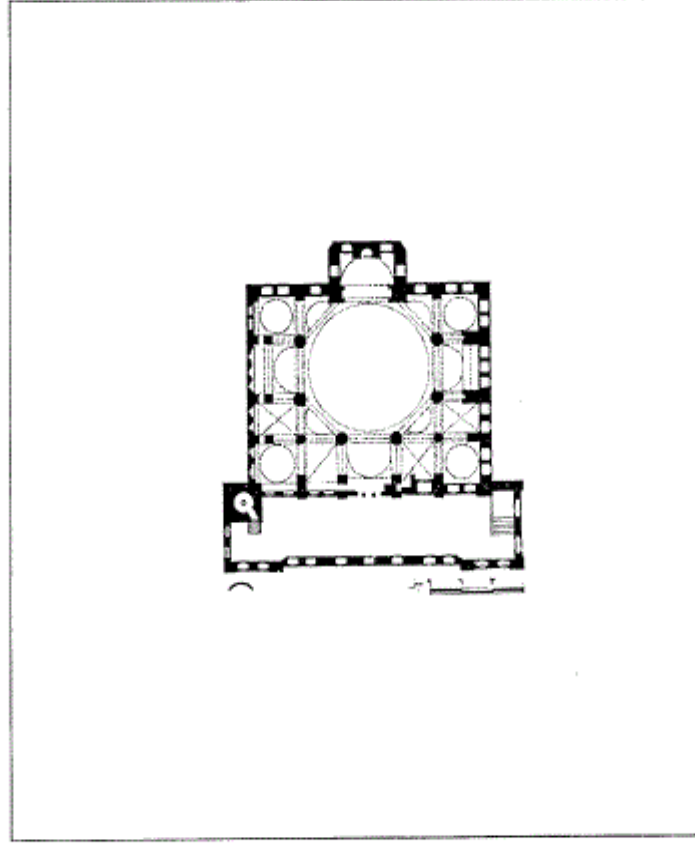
مسقط أفقي لمسجد بيالى باشا في إستانبول (عن : جابريل)
